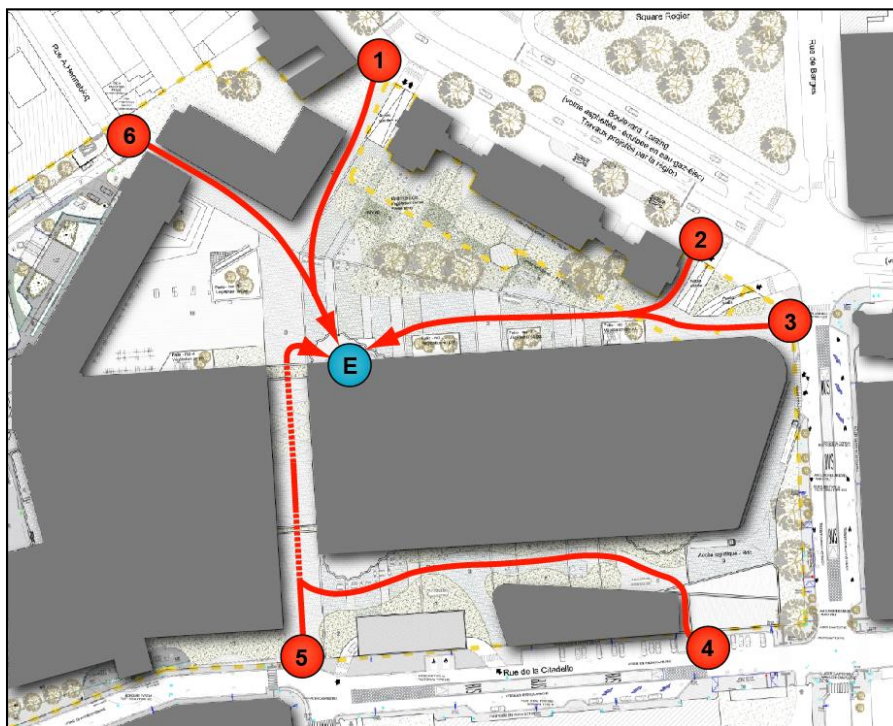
Accès et itinéraires pour rejoindre l'entrée du bâtiment (source du fond de plan : BAEV)
